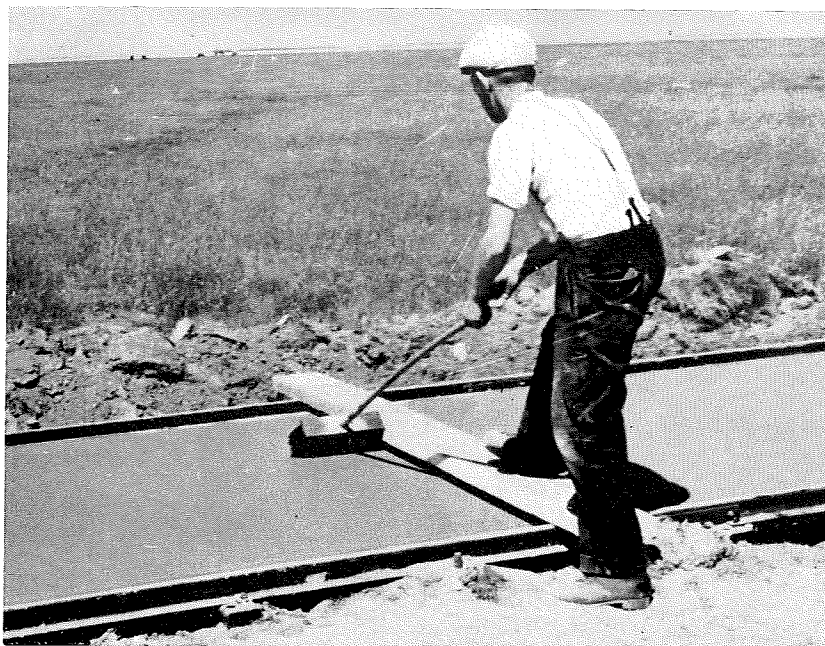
Verdichten des Betons mit einfacher Rüttelbohle (Hahn)
